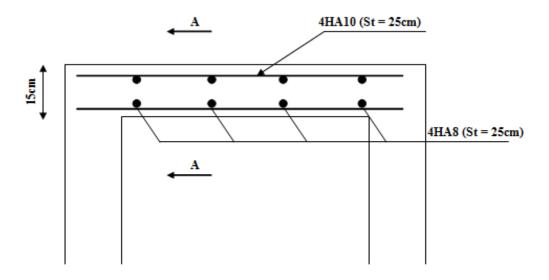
Ferraillage de la dalle de la salle machine
